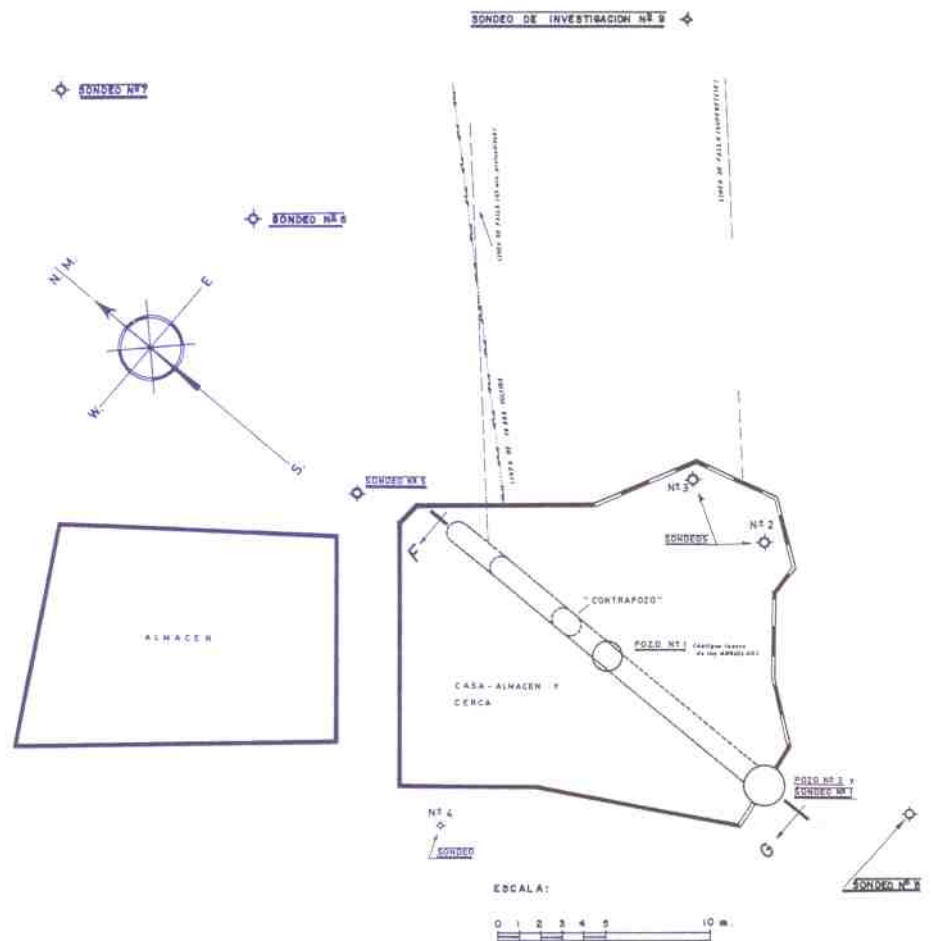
Situación en planta de los pozos y sondeos en el karst de Las Anguilas (Murcia).
